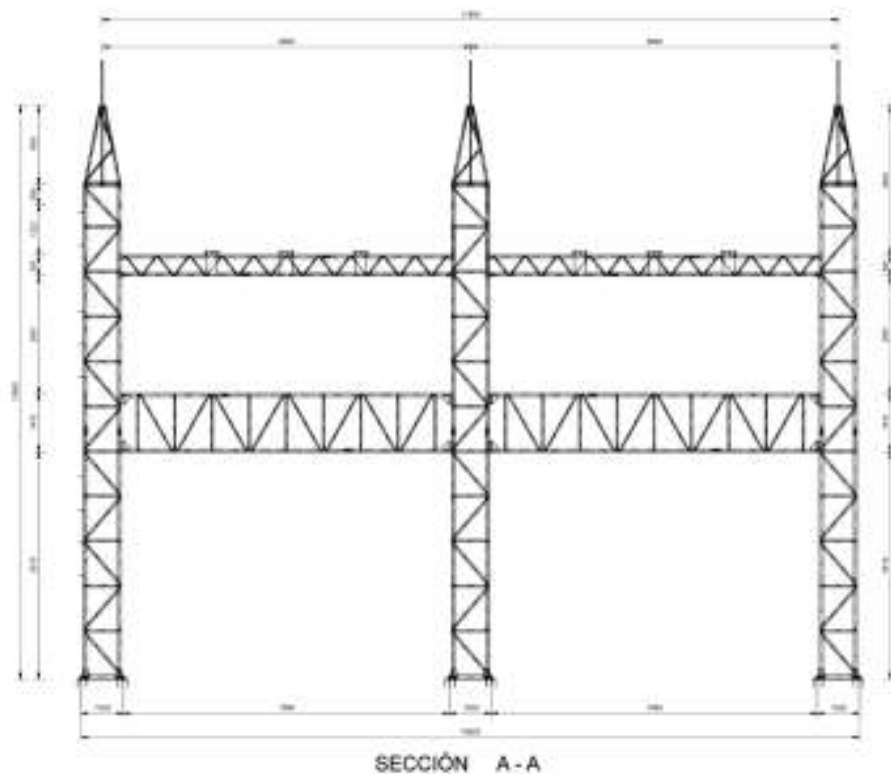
Sección A - A de la estructura metálica de la barra de 69 kV.
